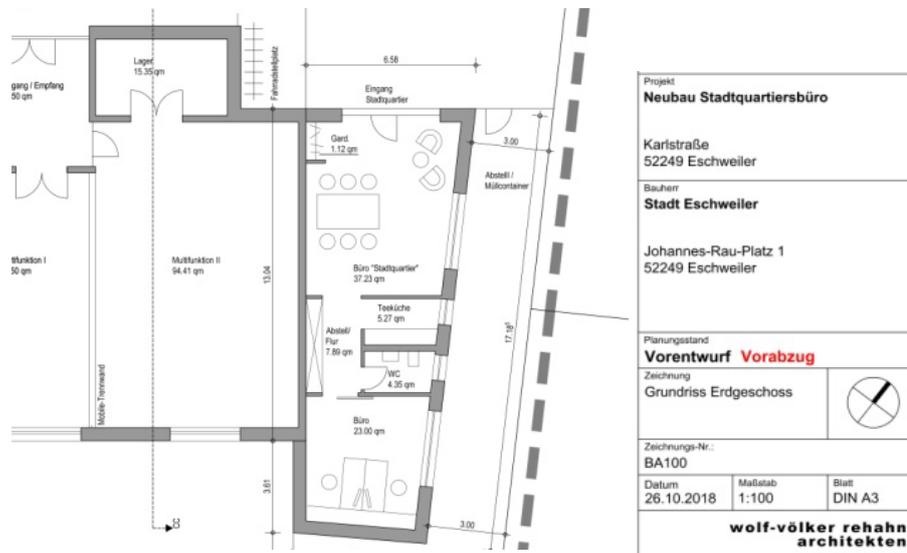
Planung Neubau Stadtteilbüro (Quelle: Stadt Eschweiler)
